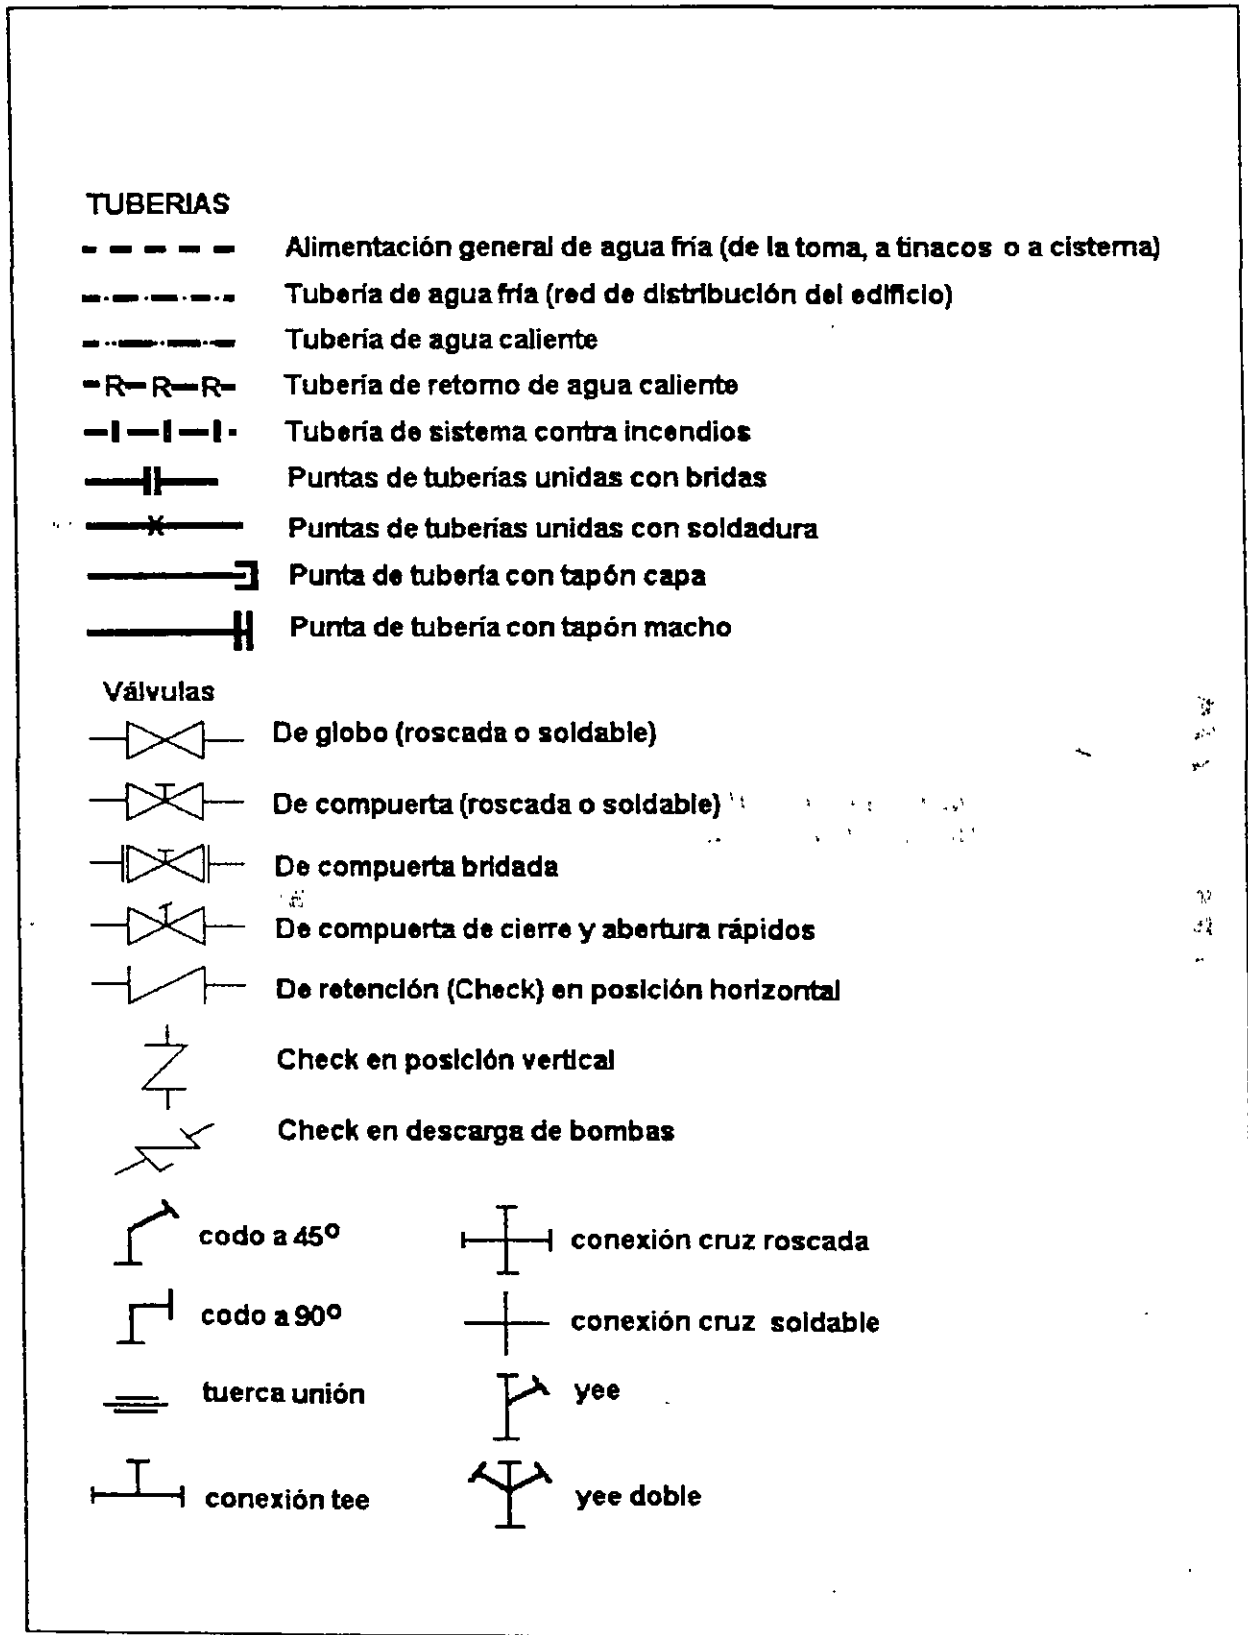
Simbología recomendada para su uso en los planos de proyecto.
